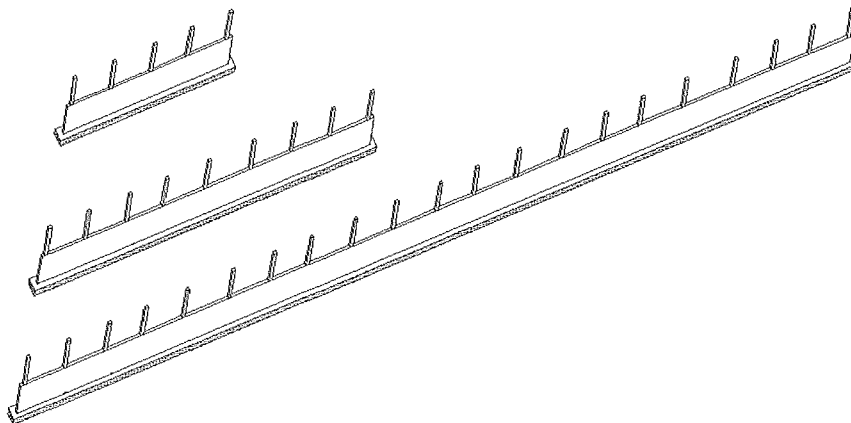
Cimentación adoptada. Zapata de 0,60 x 1,50 m y muro de sótano de sección 3,00 x 0,30 m de longitudes de 20 m, 40 m y 100 m y con separación de pilares de 5 m.
